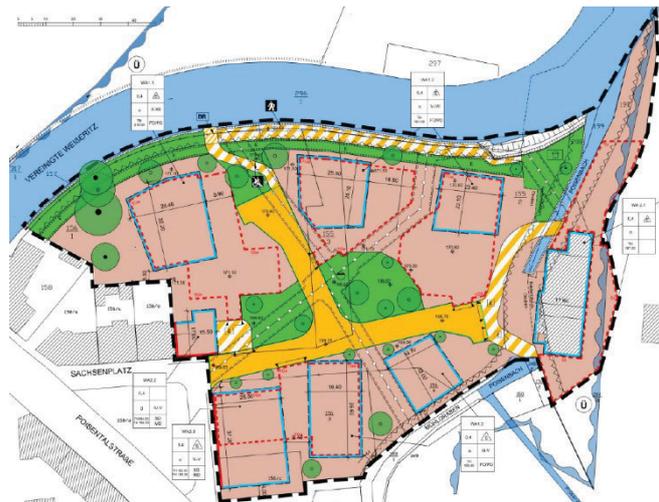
Entwurf des benachbarten Bebauungsplanes „Wohnareal am Sachsenplatz“ vom 06.04.2021 von WERKplan.
